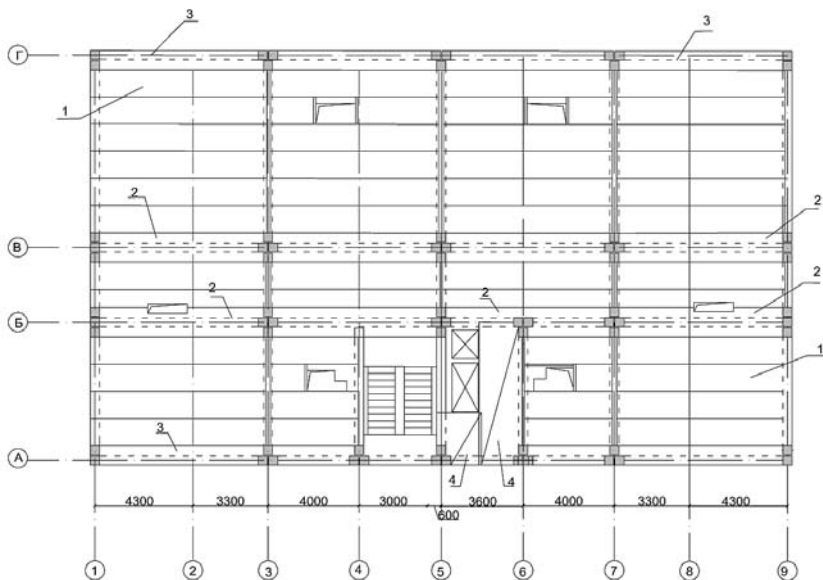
Расположение плит перекрытий и связевых плит: 1 – рядовые плиты перекрытий; 2, 3 – связевые плиты; 4 – плиты перекрытий лестнично-лифтового узла
